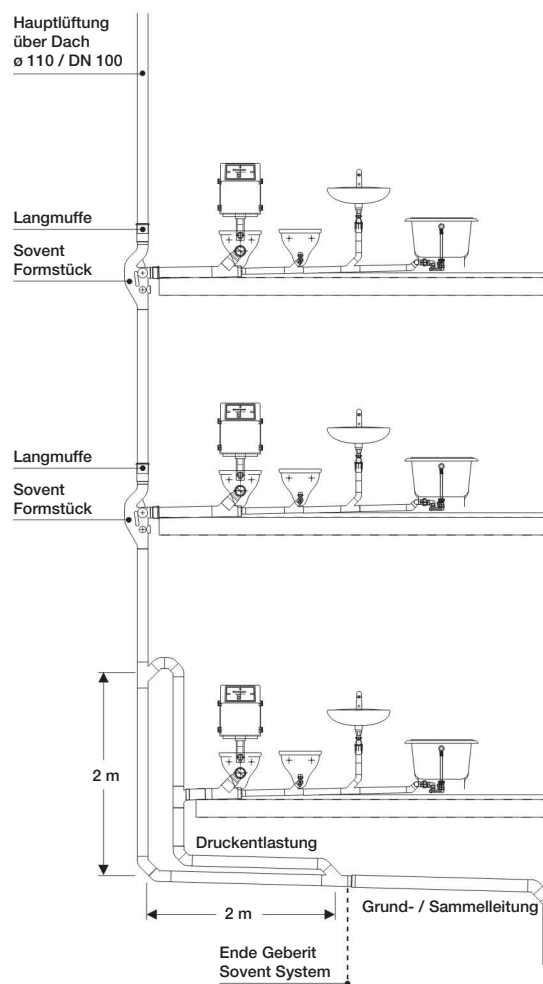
Installationsbeispiel mit Geberit PE-HD Sovent Formstück
